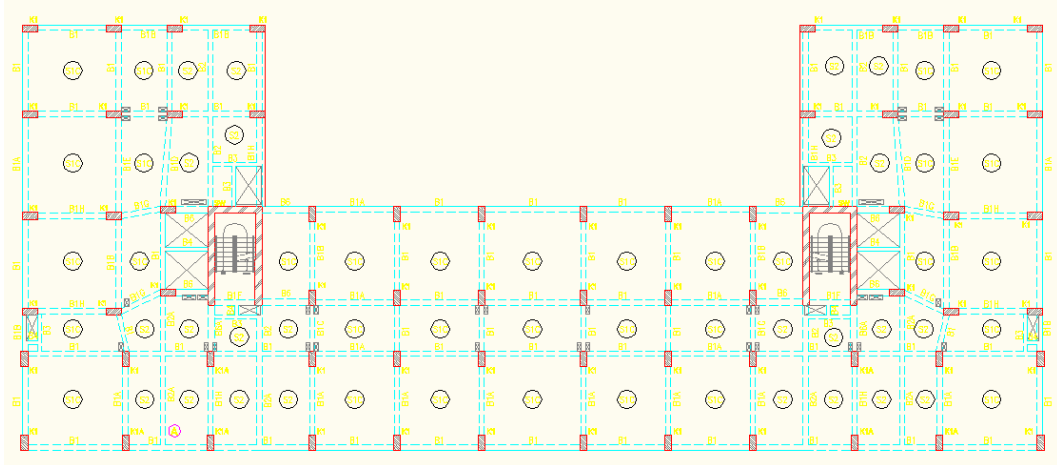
denah struktur tipe I (tanpa dinding geser)
